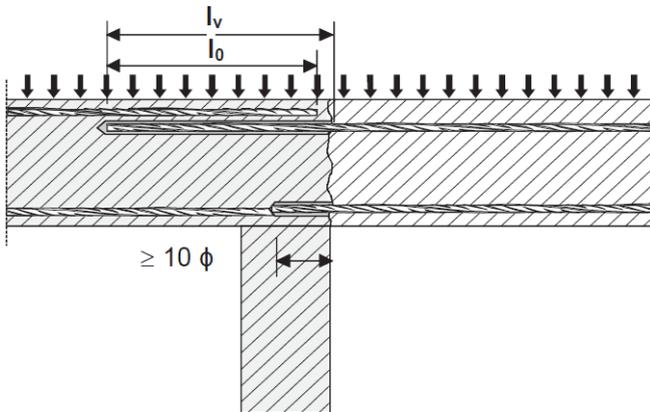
Ancrage en extrémité de dalles ou poutres en appui simple.
